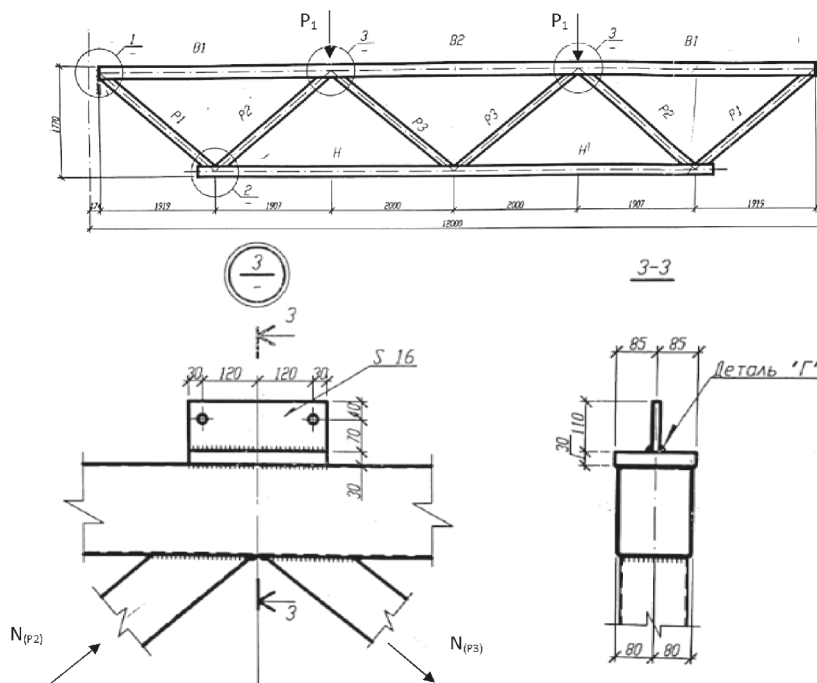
Конструкция подстропильной фермы и ее узлы в месте опирания стропильной фермы
